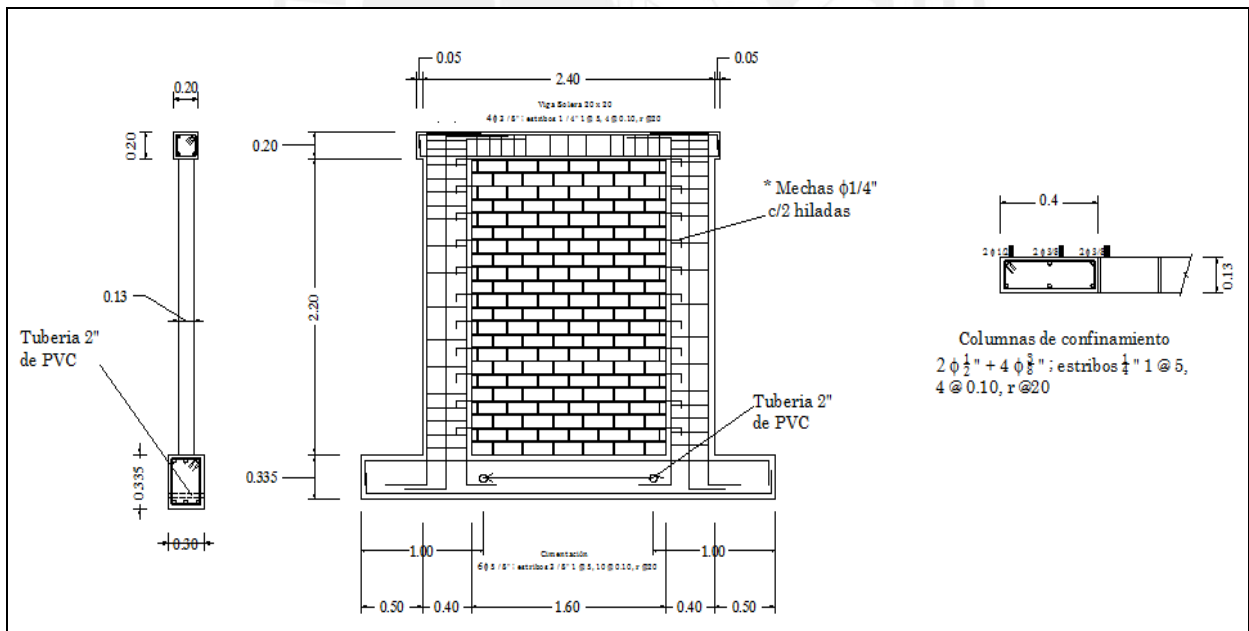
Muro M2, peralte de columnas de 40 cm.
